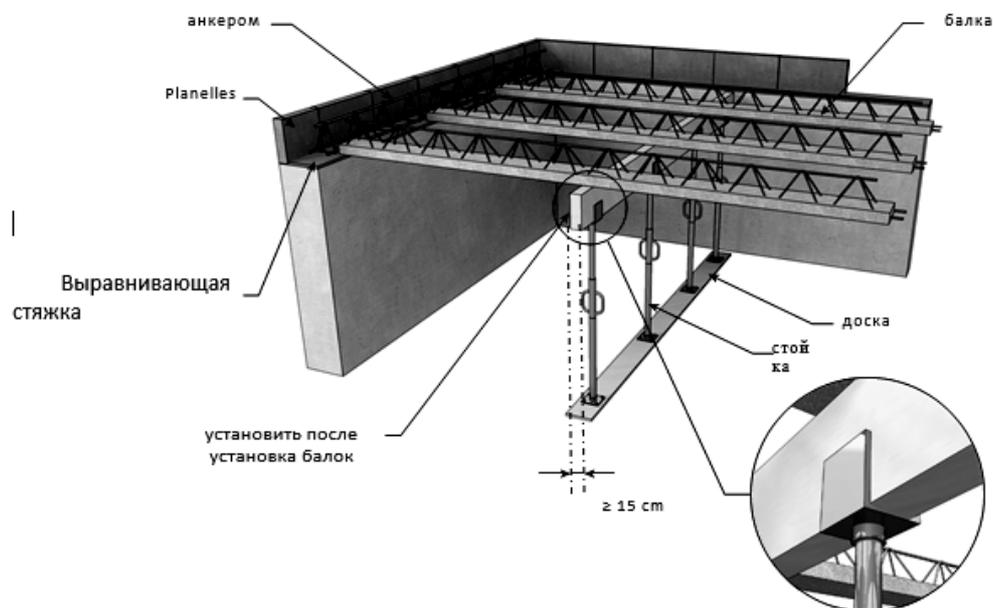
Установка опор сборно-монолитных перекрытий Teriva [13]
